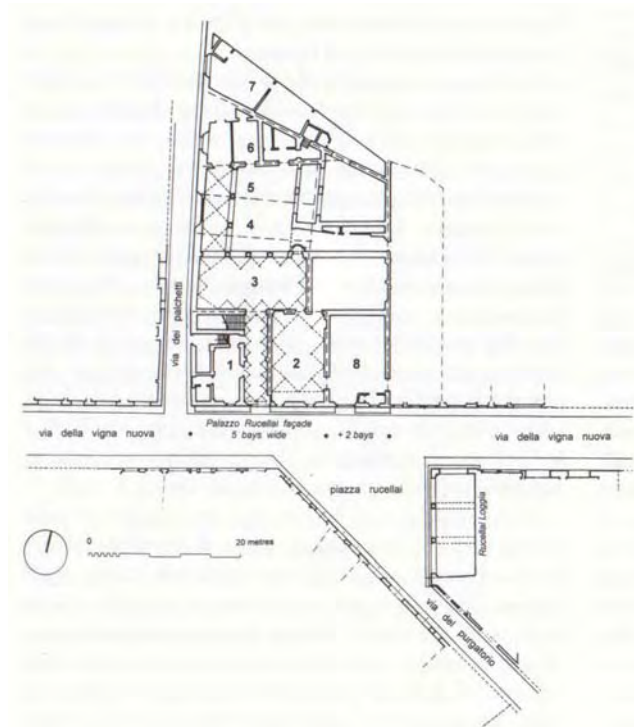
Planta baixa do pavimento térreo do *Palazzo Rucellai*, onde os números indicam a posição das oito edificações originais que formaram o palácio (TAVERNOR, 1998, p. 82).
